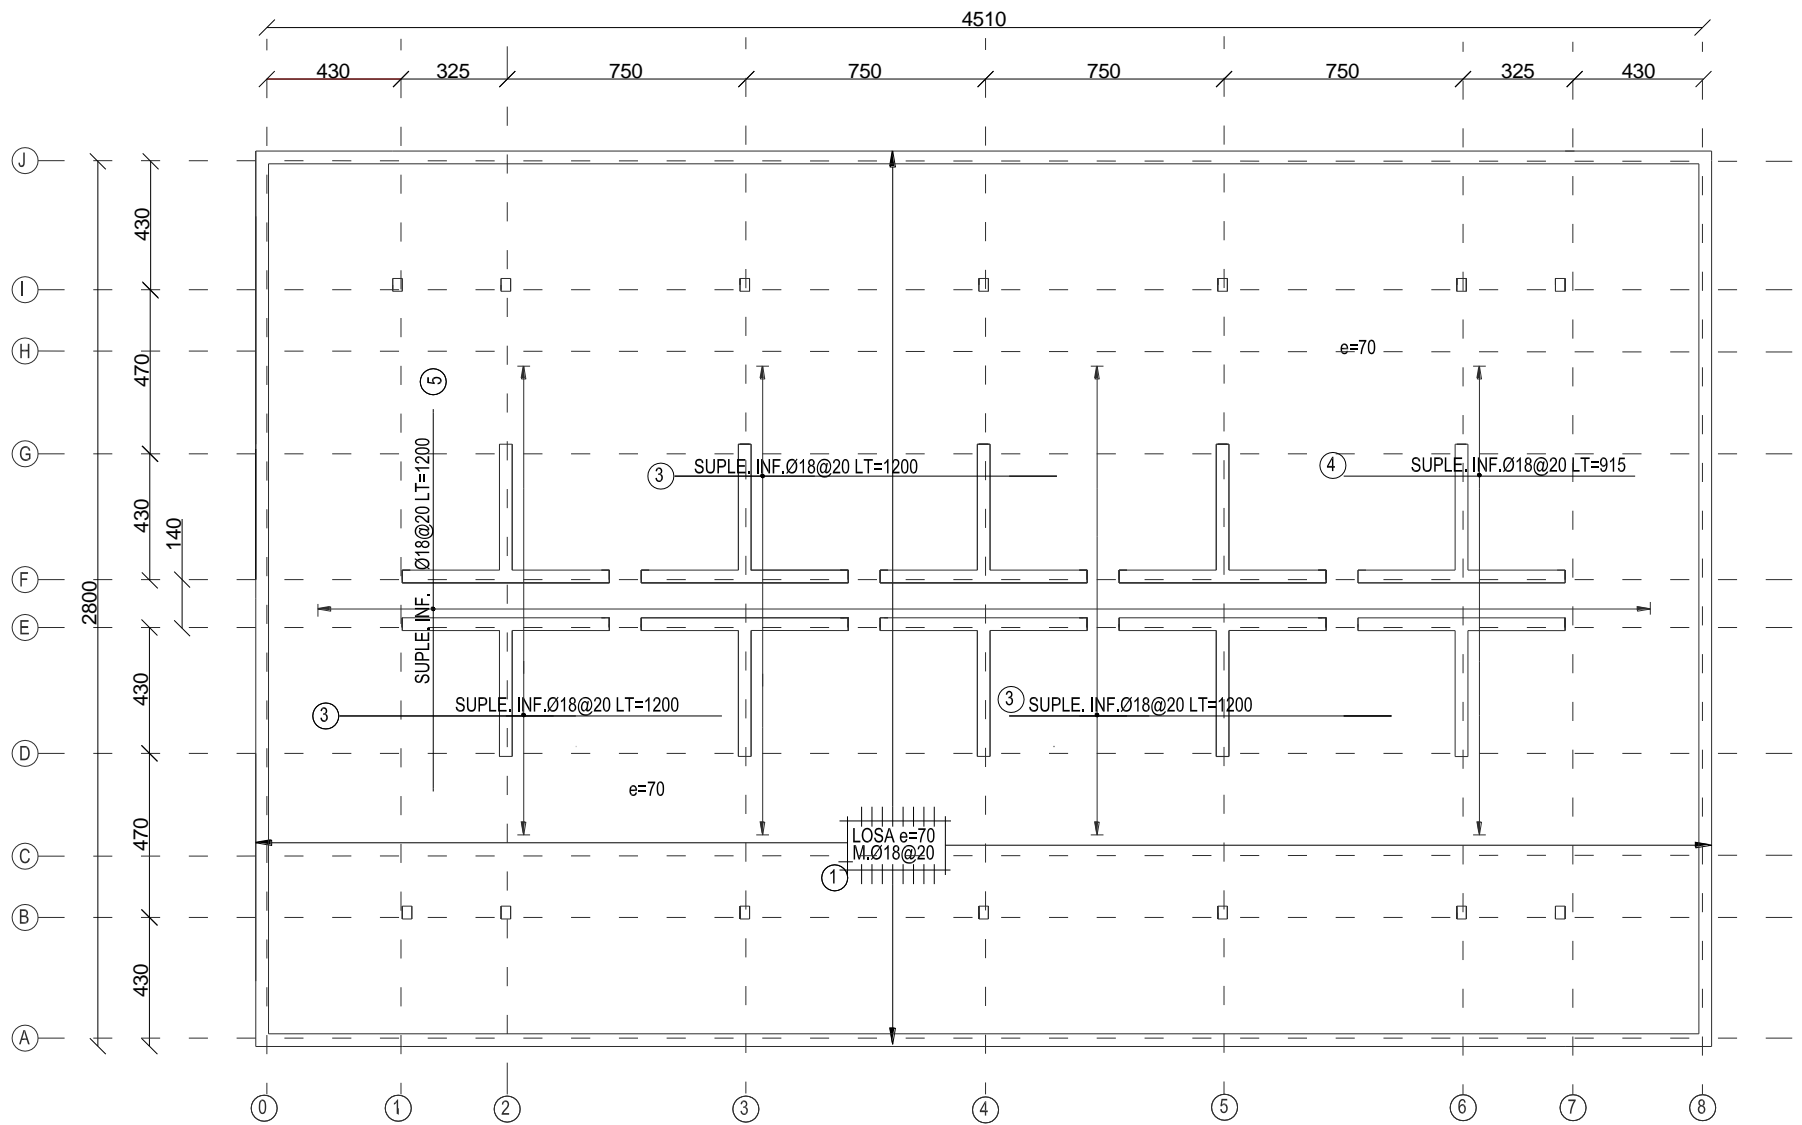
Planta losa de fundación armadura inferior de edificio tradicional.
